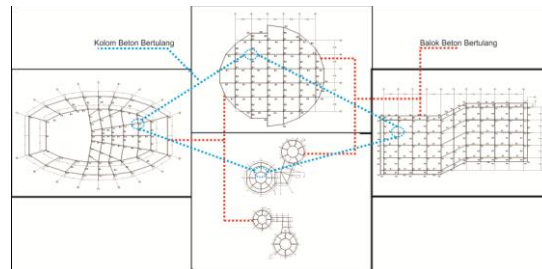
Sistem Struktur Bawah ( Pondasi )
